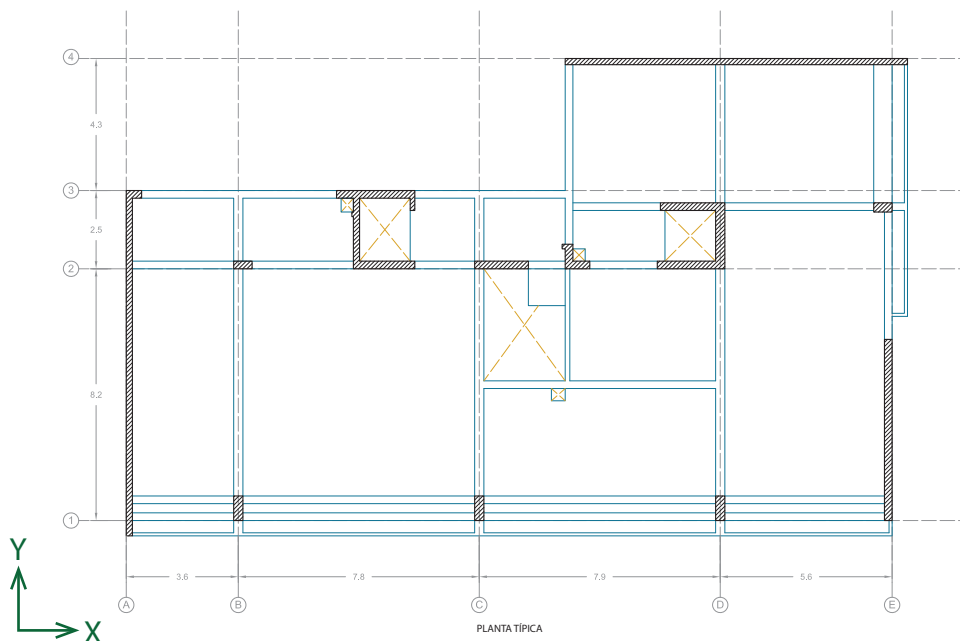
Vista en planta del edificio de vivienda multifamiliar.
